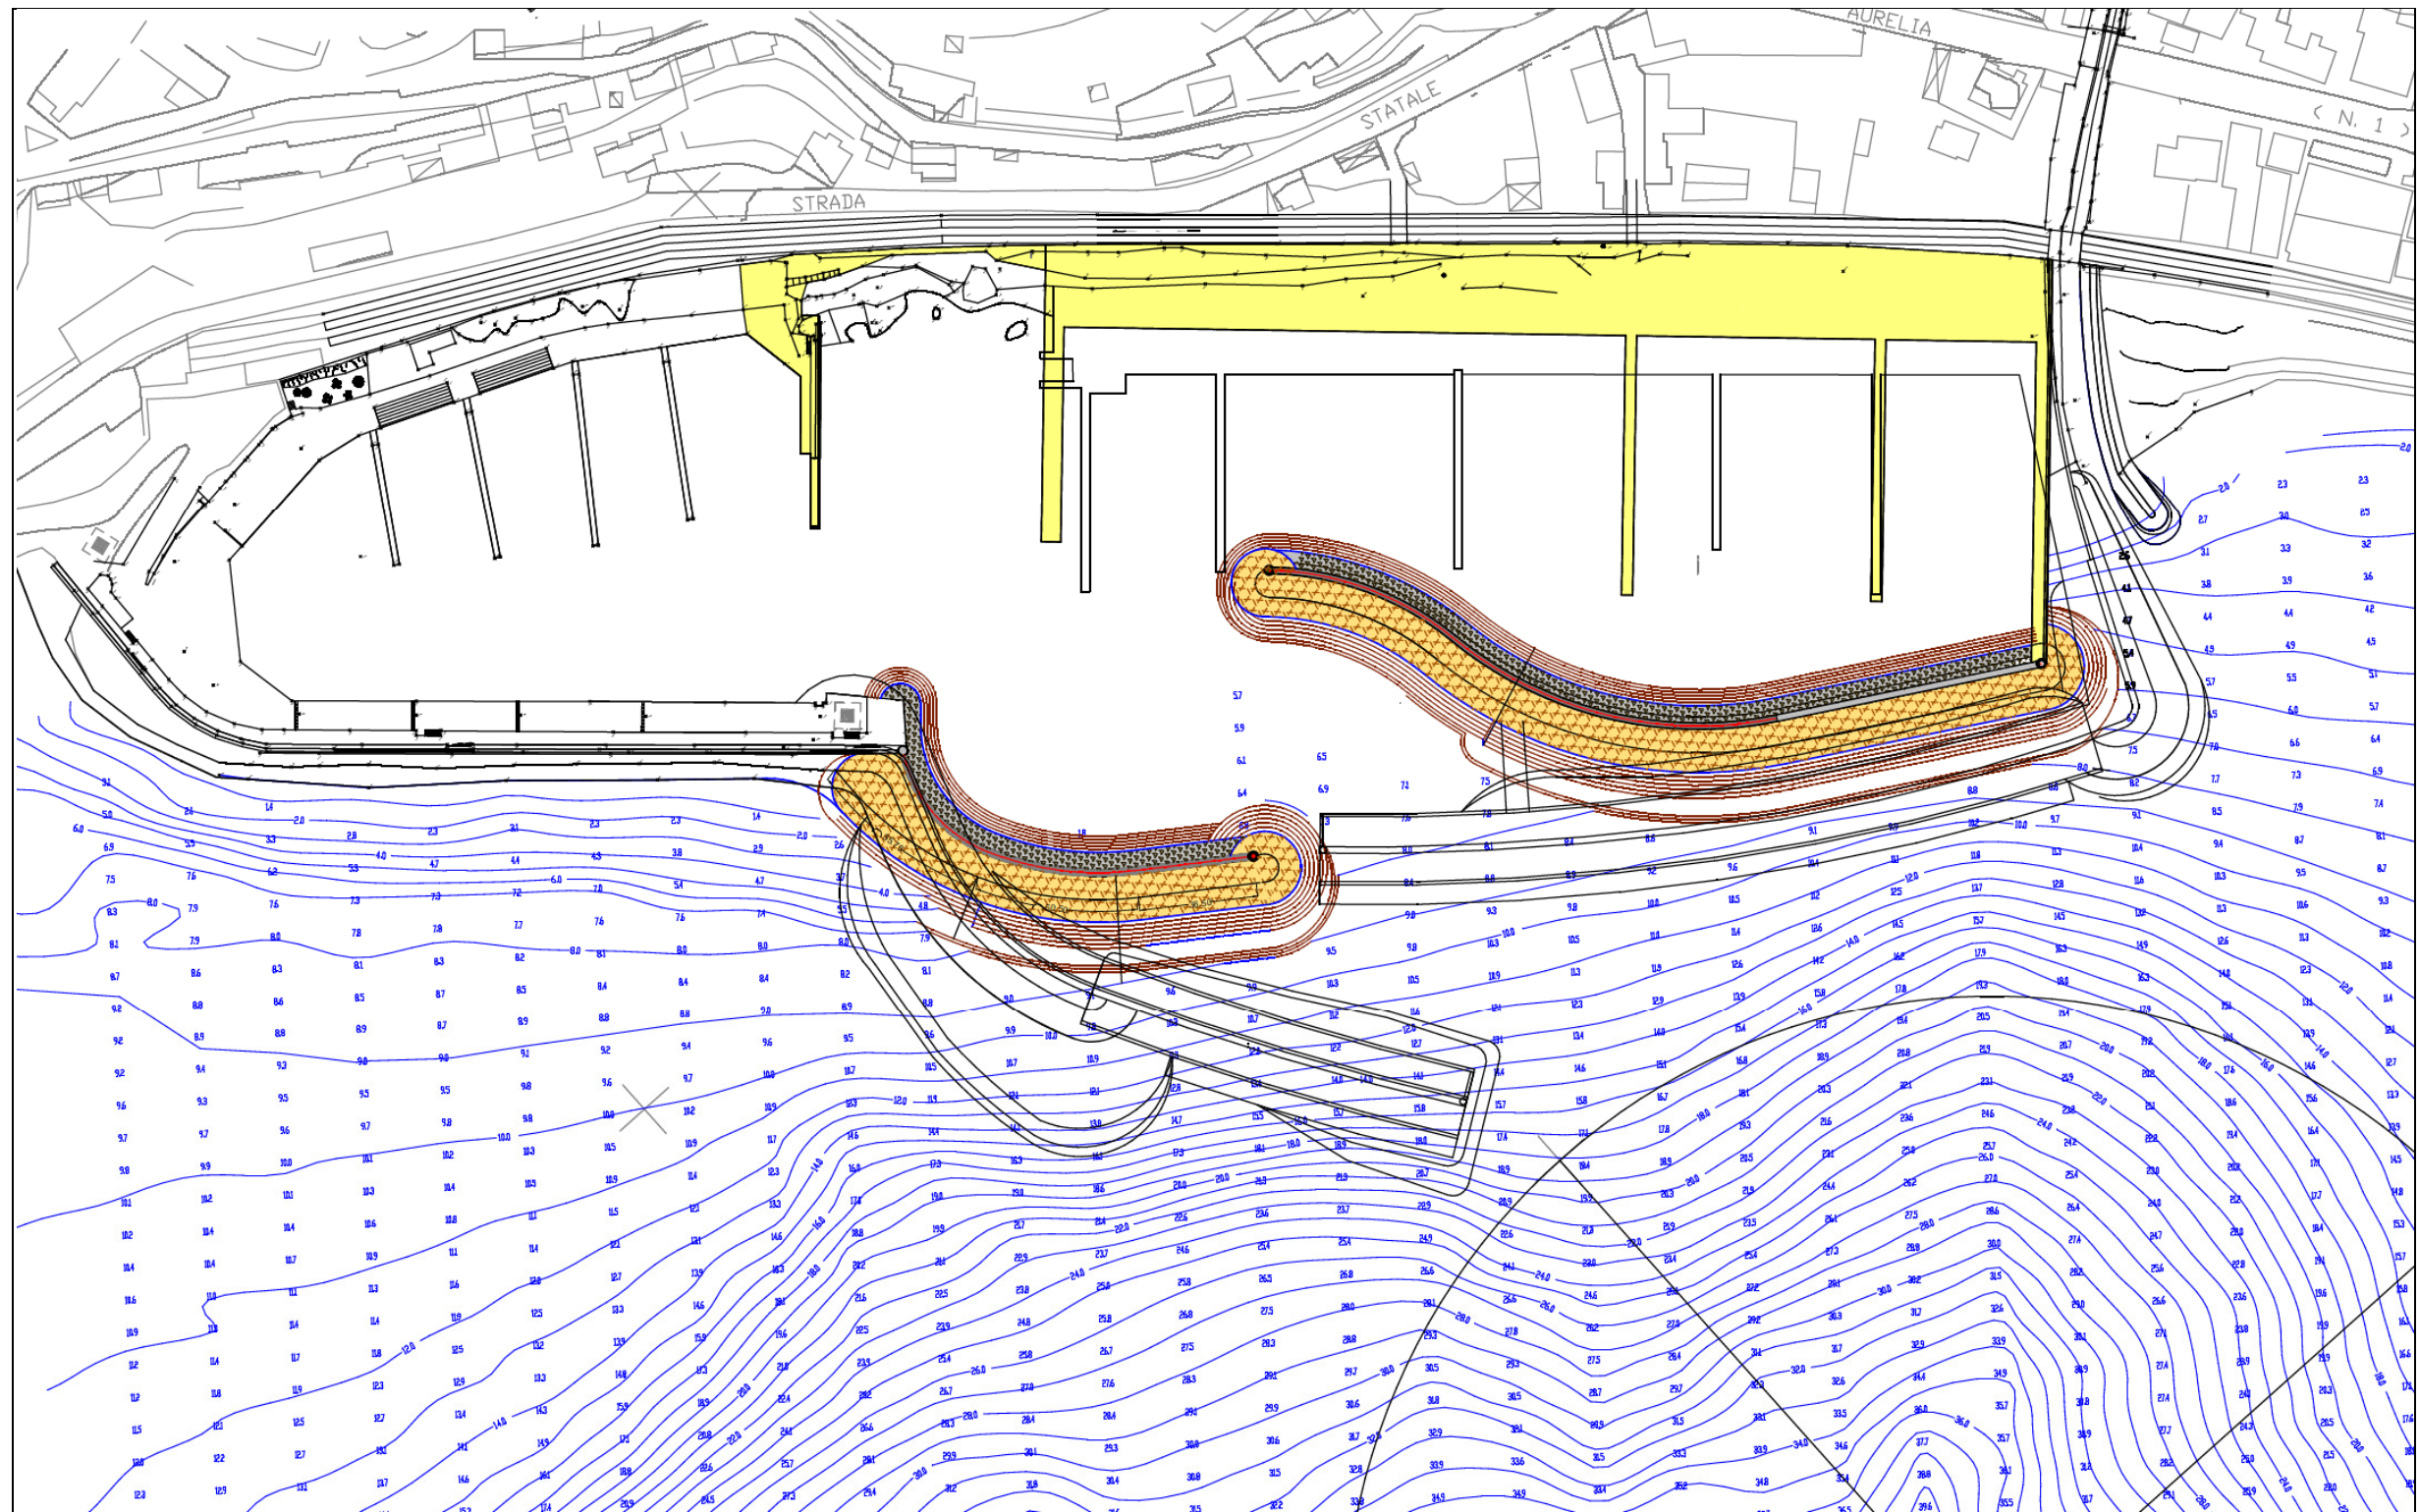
Sovrapposizione del nuovo layout al layout precedente (in giallo le nuove banchine)
